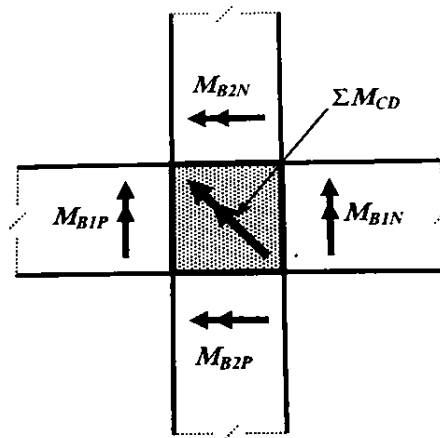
Joint Centroid* pada Lantai bukan *Roof Top
